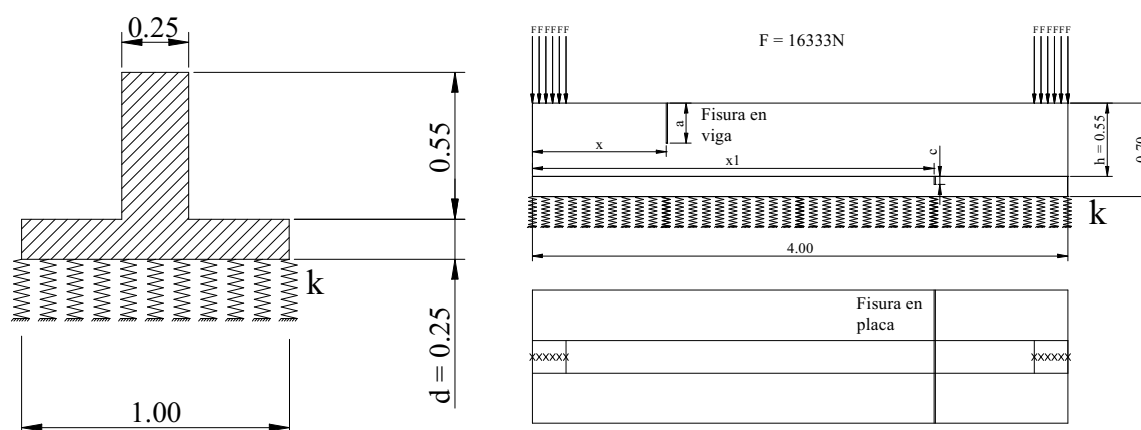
Modelo de Viga de Fundación con fisura en la viga y en la placa (unidades de long. en metros).
